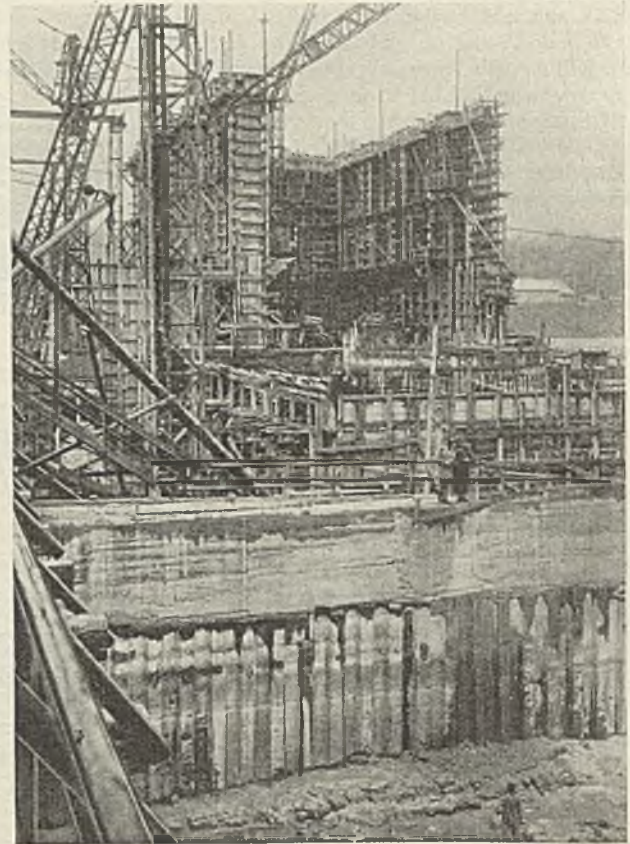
Rechte Krafthausbaugrube, im Hintergrunde Verschalung des Hochbaues der linken Krafthaushälfte.
